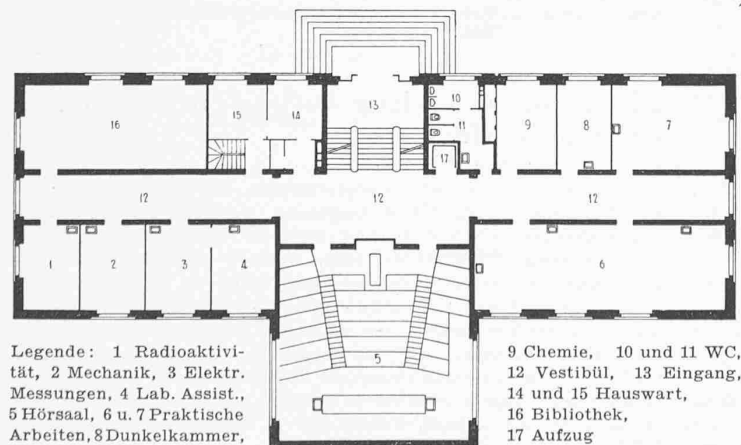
Grundriss vom Erdgeschoss 1:400
